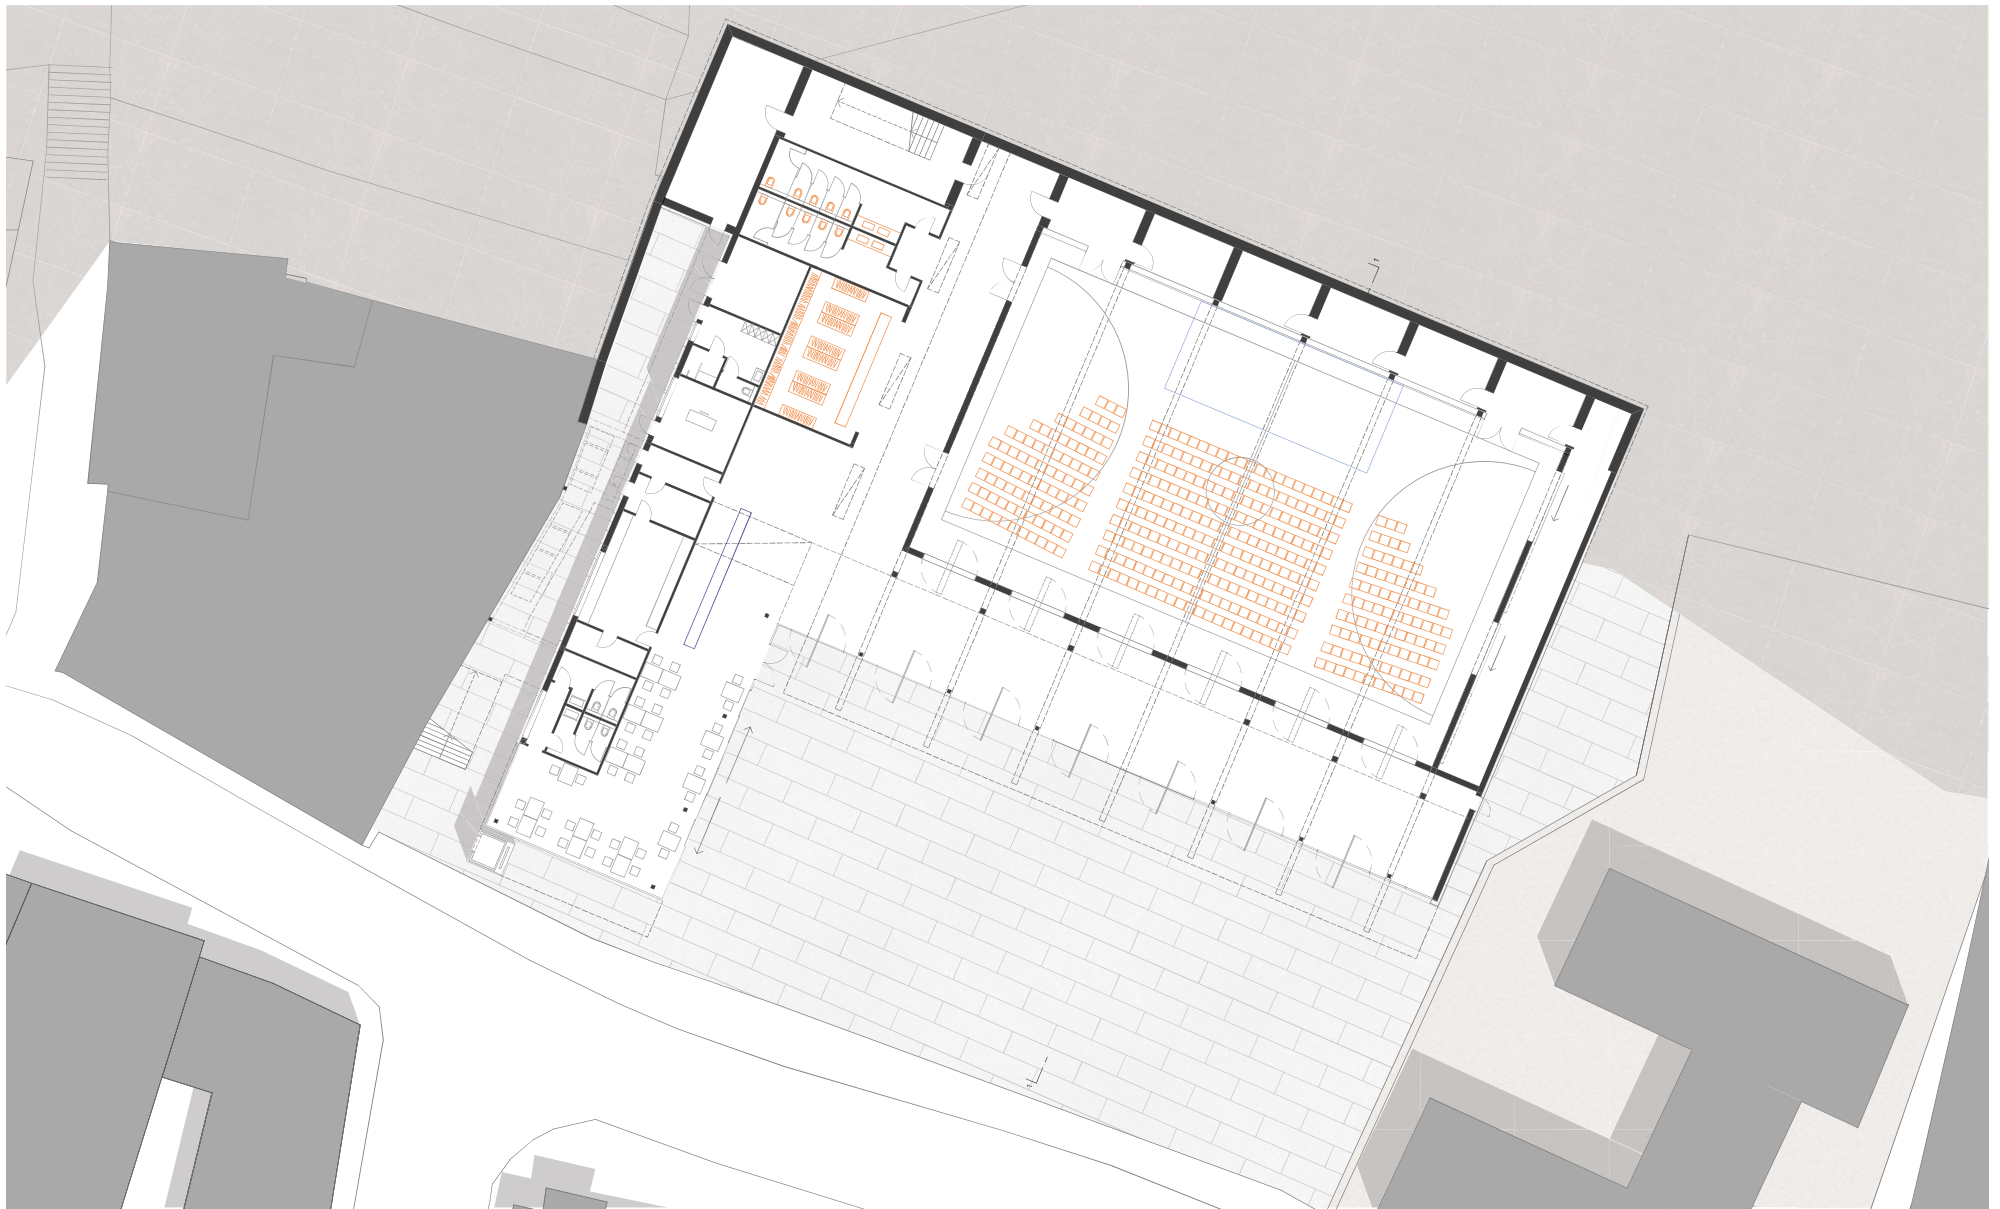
Grundriss Erdgeschoss - Szenario Konzert
